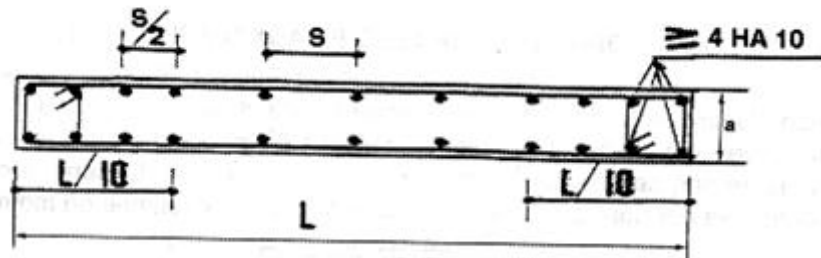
Disposition des armatures verticales dans les voiles
